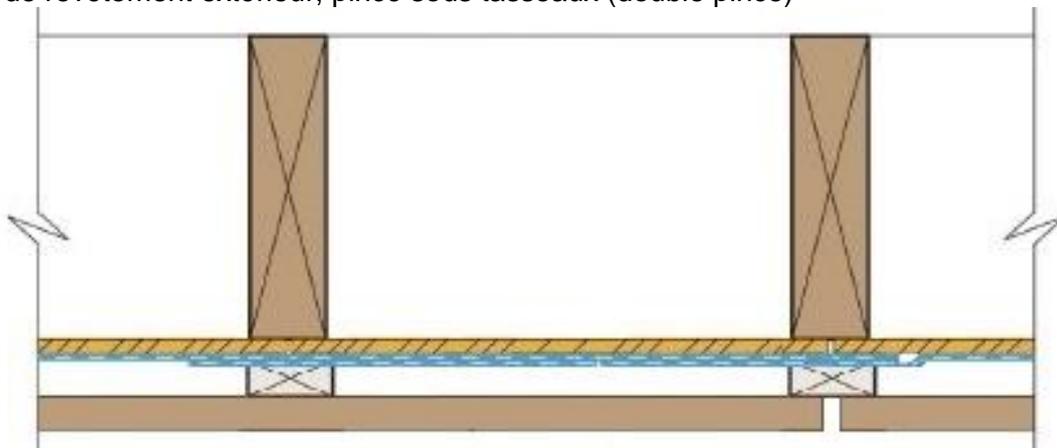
Double recouvrement à sec derrière un bardage à joints ouverts (coupe horizontale)
